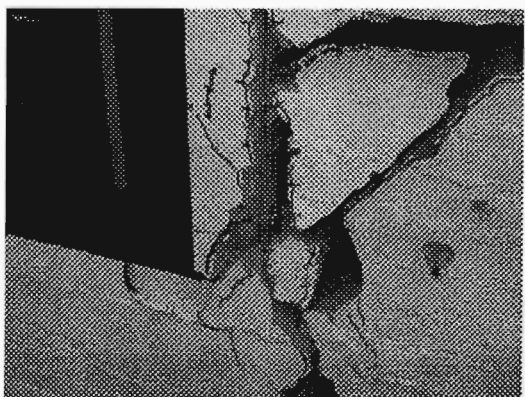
Agrietamiento final en la fachada Sur
